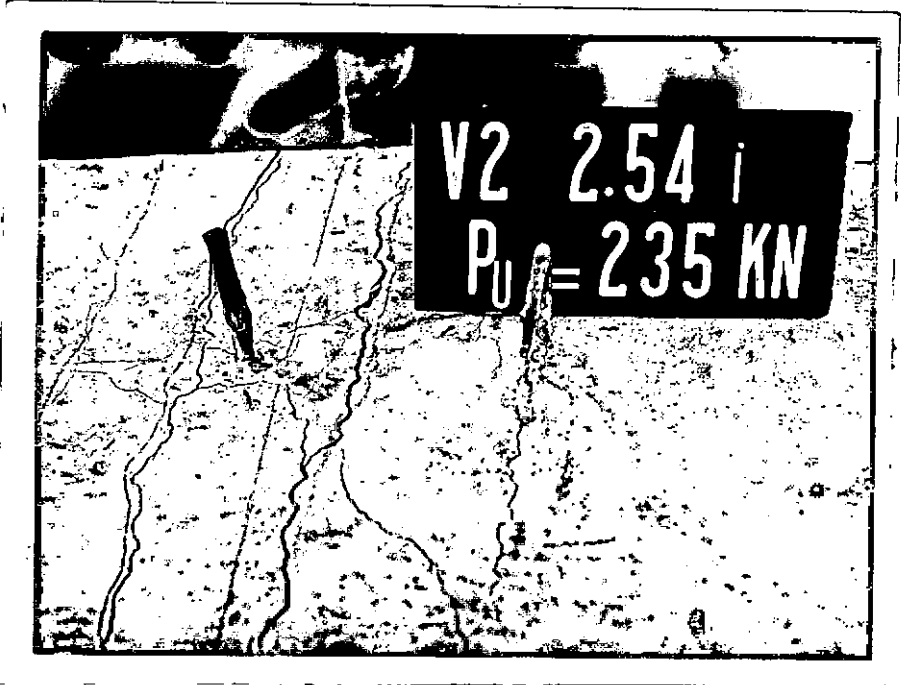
Fissuração na mesa superior da V2-2,54-I
